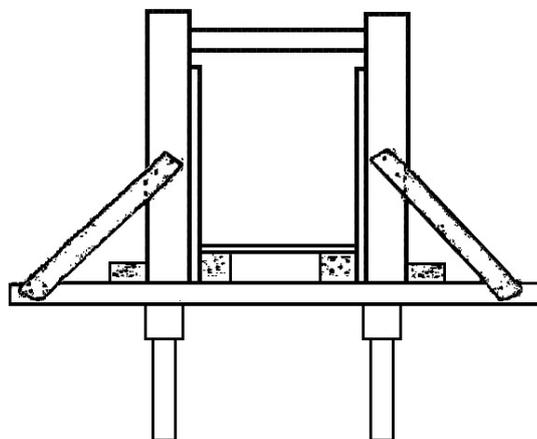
Konstruksi tepi pada pelat lantai beton balok T maupun yang datar
